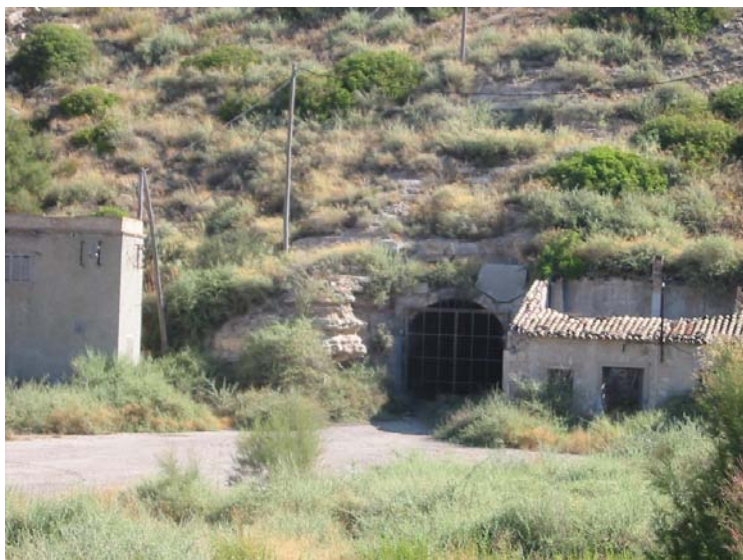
Mina Virgen del Pilar. Galería principal por donde salía el ferrocarril.
